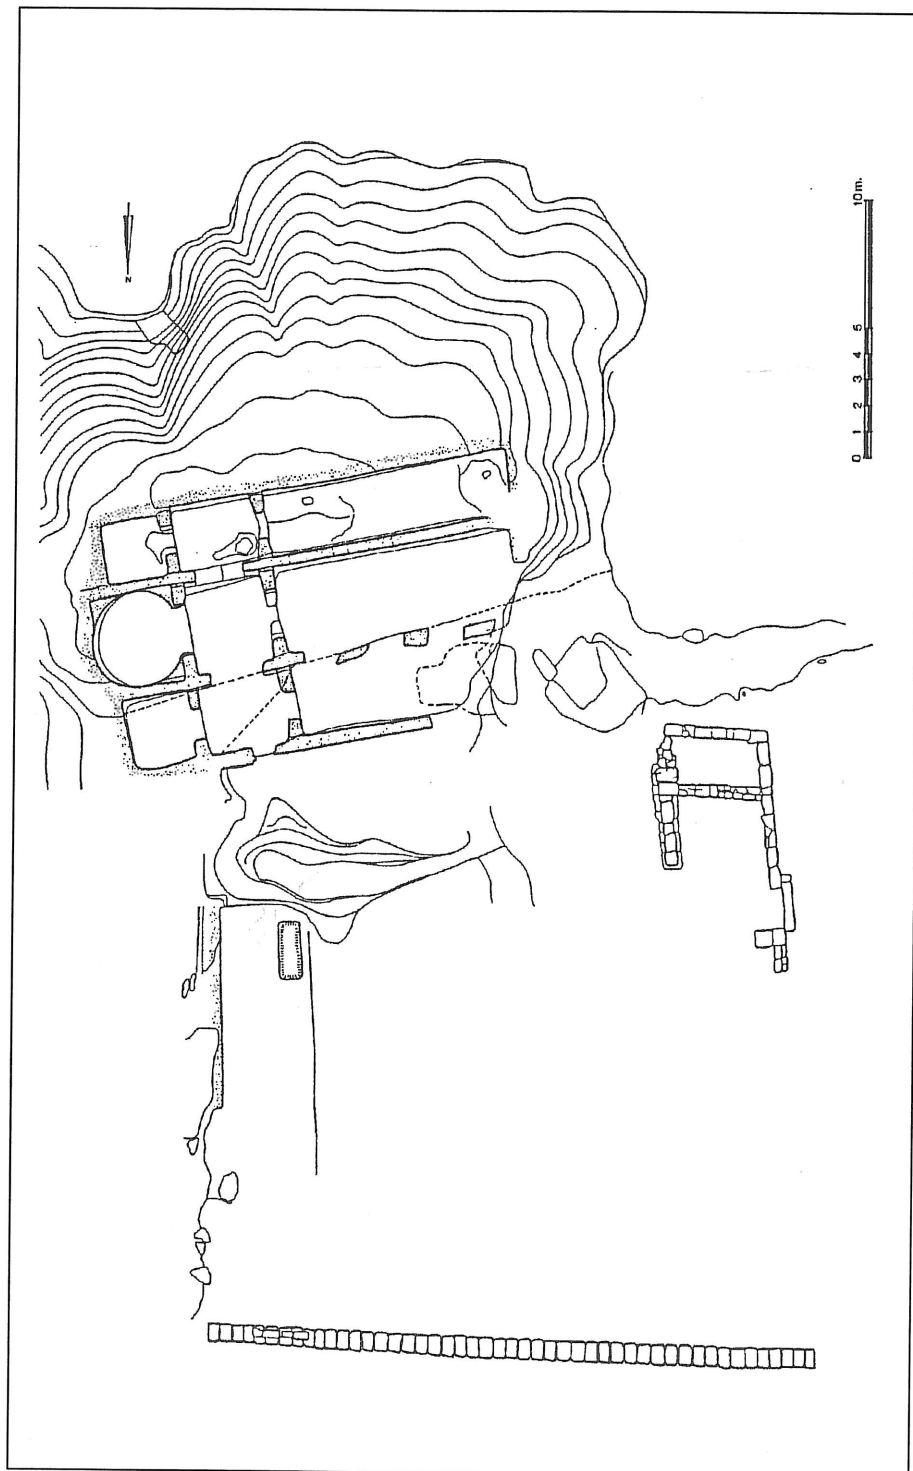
Bobastro. Ardales (Málaga). Planta (según: Puertas Tricas)
